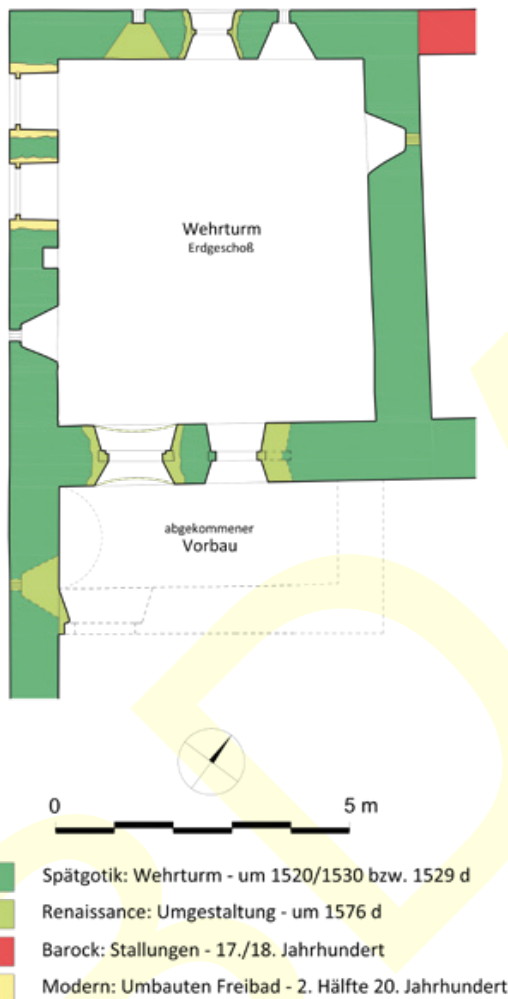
Döllach, Schloss Großkirchheim, Wehrturm. Baualterplan des Erdgeschoßes.
